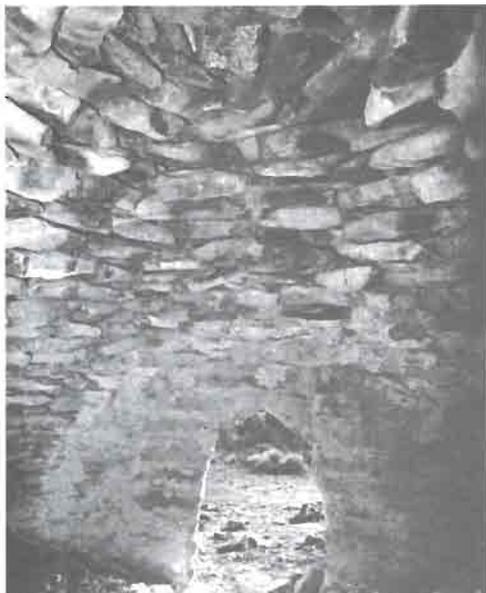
Interior del Cuco de los Garganchines donde se aprecian las hiladas en voladizo.
